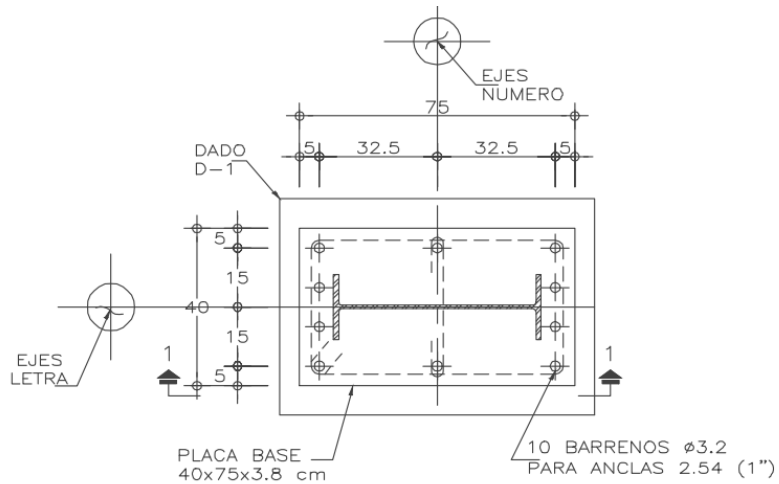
Detalle planta estructural de cimentación. Elaborada por el autor
